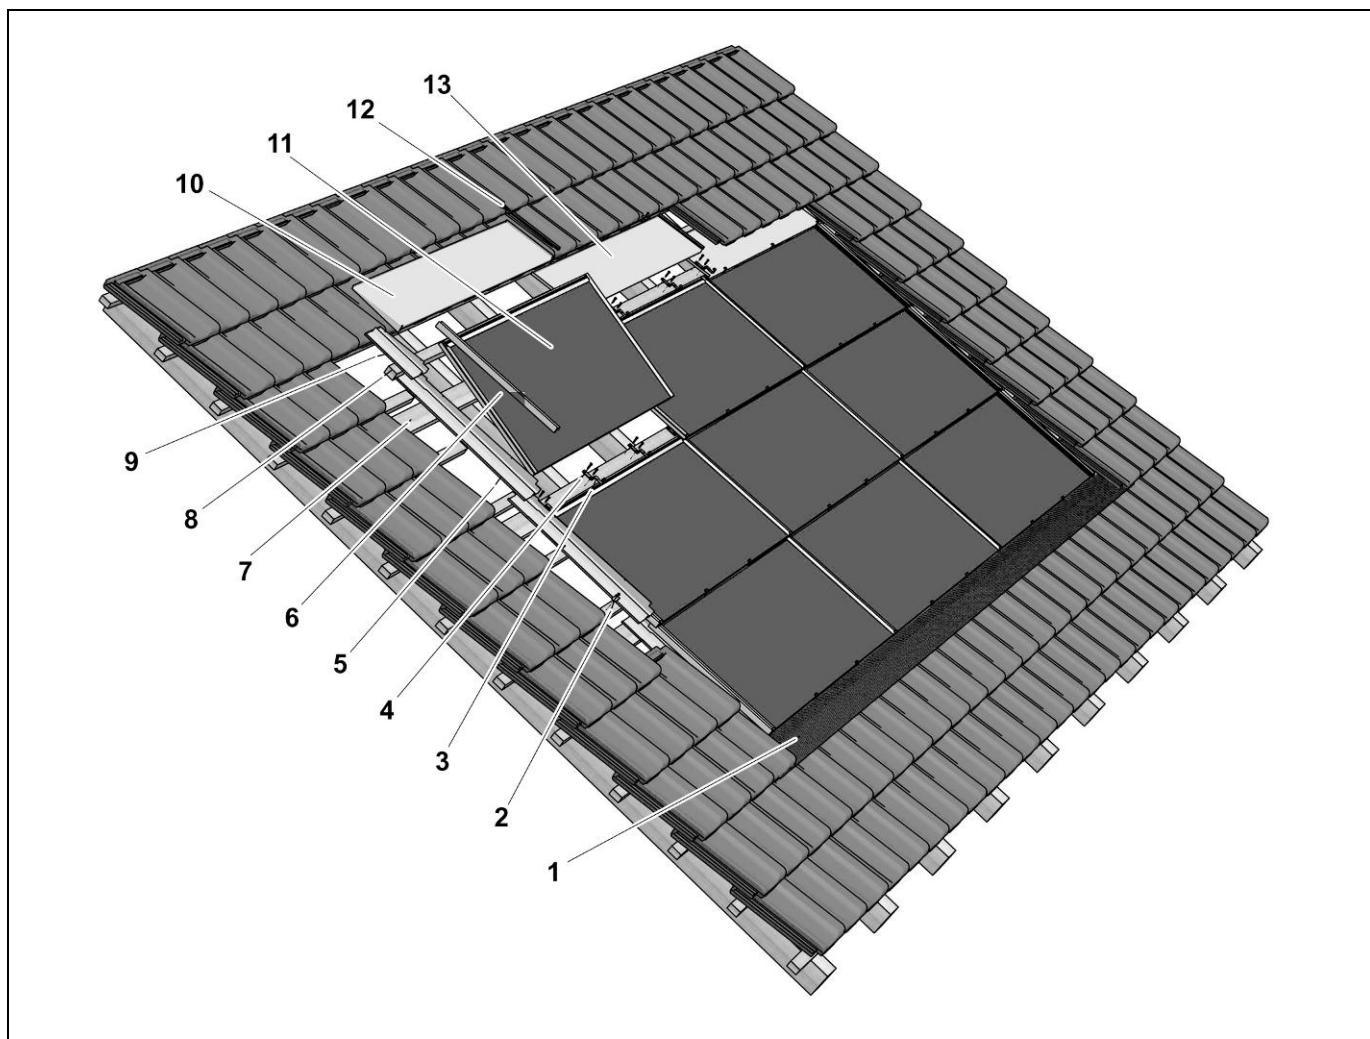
Vista esplosa dell'impianto fotovoltaico
